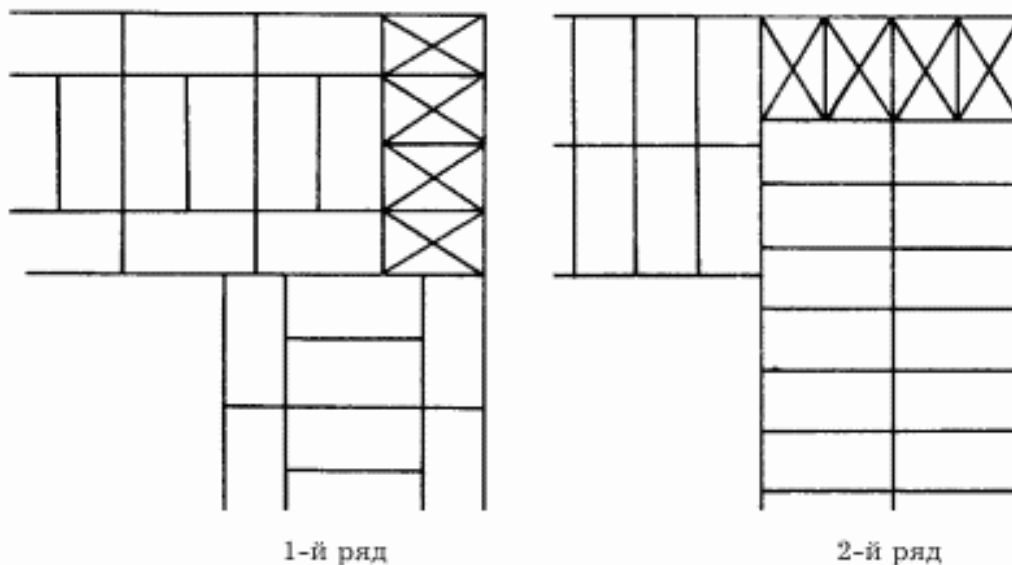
Кладка угла стены в два кирпича при двухрядной перевязке.
